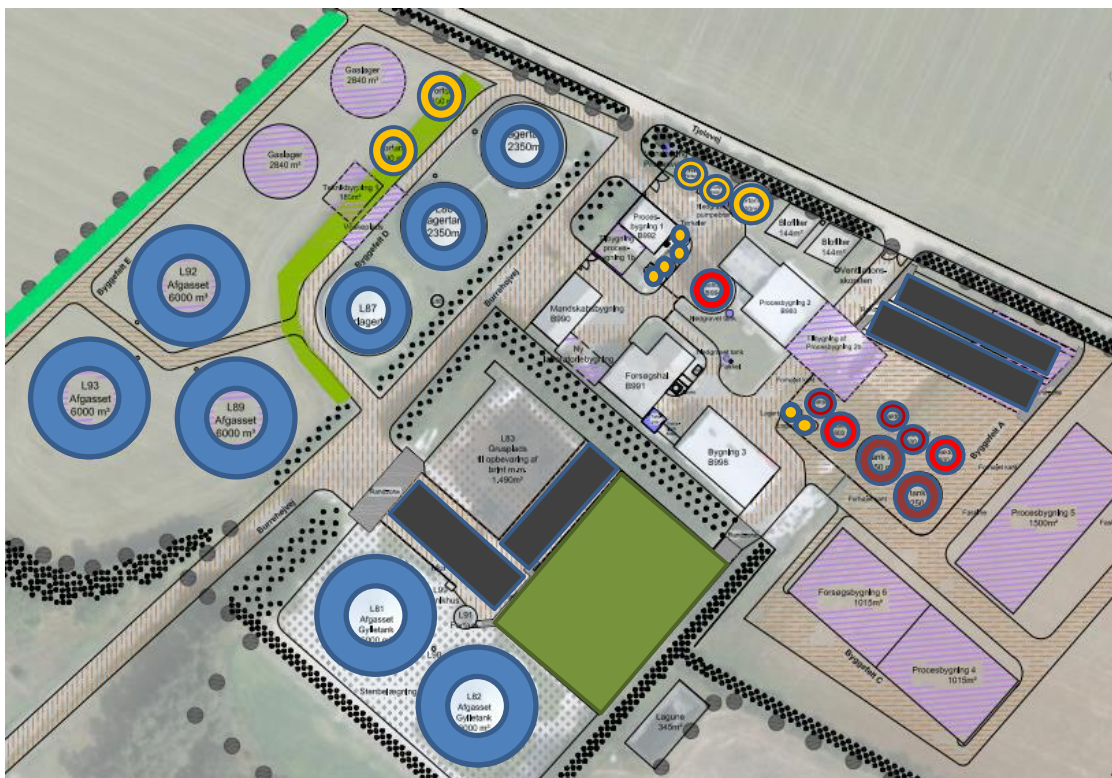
Placering af beholdere, tanke og plansiloer efter udvidelse af biogasanlægget.
